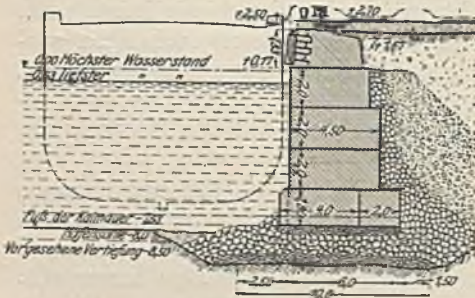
Gründung einer Kaimauer aus Betonblöcken auf einer Steinschüttung in Haider Pascha.
